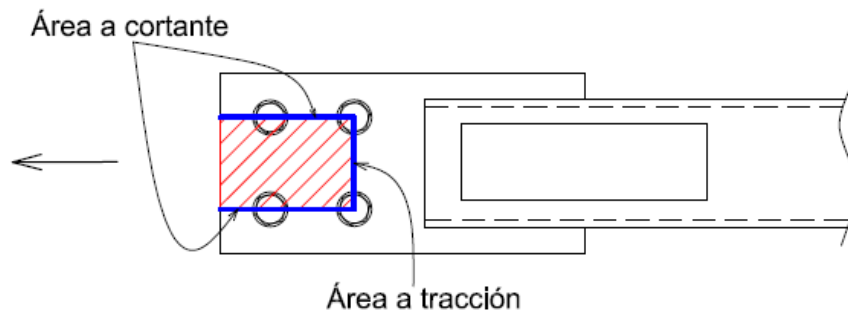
Bloque de corte en plancha PL1-forma en C
